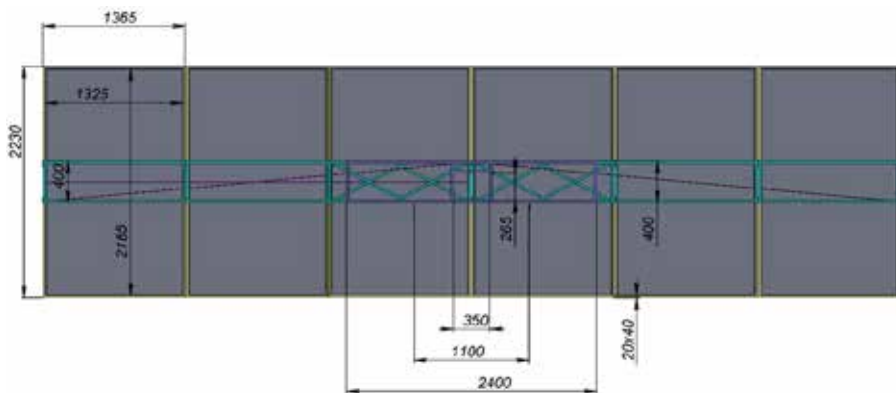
Кріплення ФМ до ферми несучої конструкції
